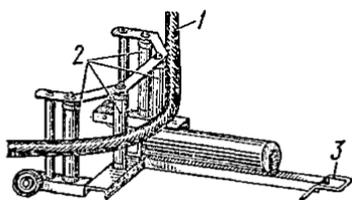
Установка роликов для прокладки кабелей под углом: 1 — кабель, 2 — ролики, 3 — кольцо для оттягивания конструкции
